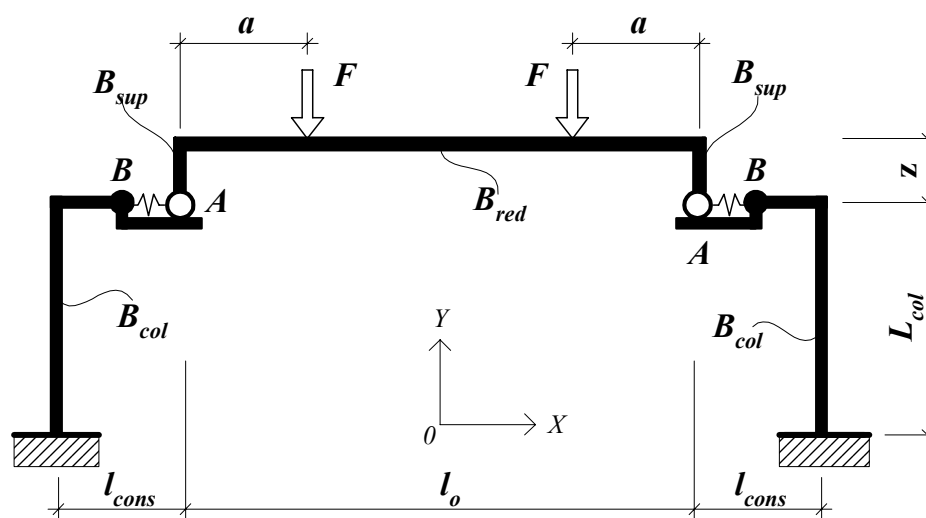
Розрахункова схема однопрогонової одноповерхової рами з шарнірним поєднанням П-подібної розрахункової моделі балки до консолей колон та з бетоном замонолічування між торцями балки та колонами
